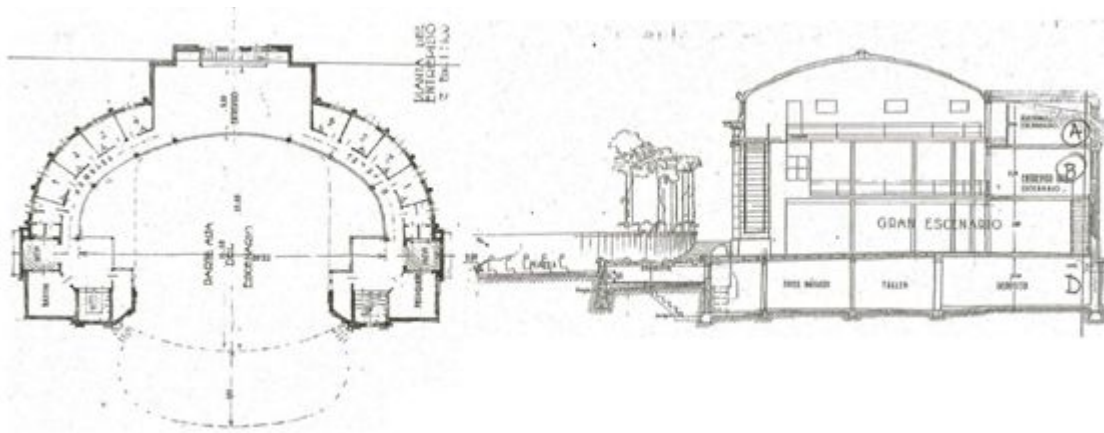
Planta y corte del edificio, planos históricos. Fuente: Ucalp.
